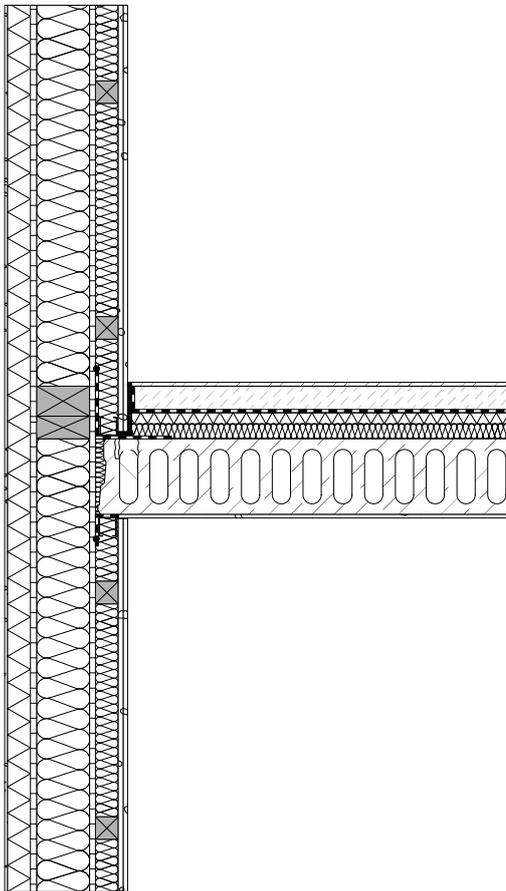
Anschluss Außenwand WA1-3 - Hohldieleendecke DE2
